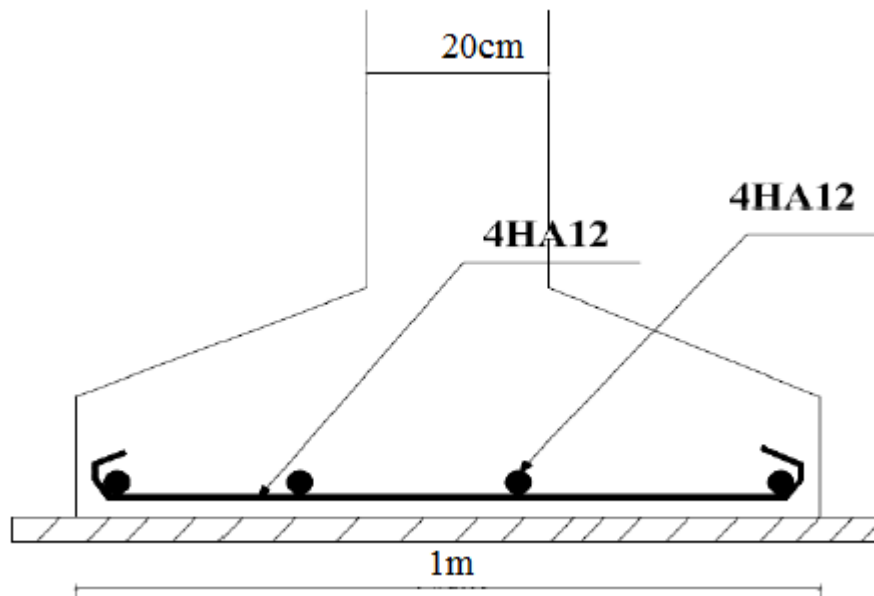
Représentation du ferrailage de la semelle du potelet
